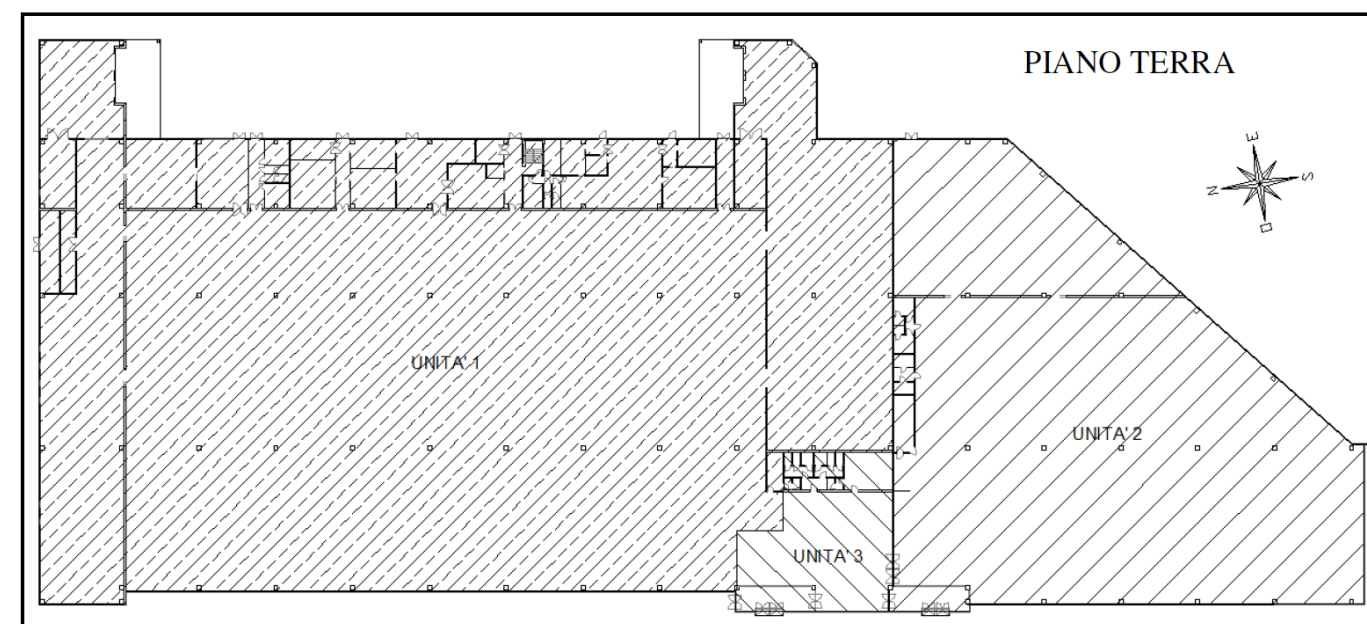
Planimetria dell'edificio ad uso commerciale suddiviso in unità
